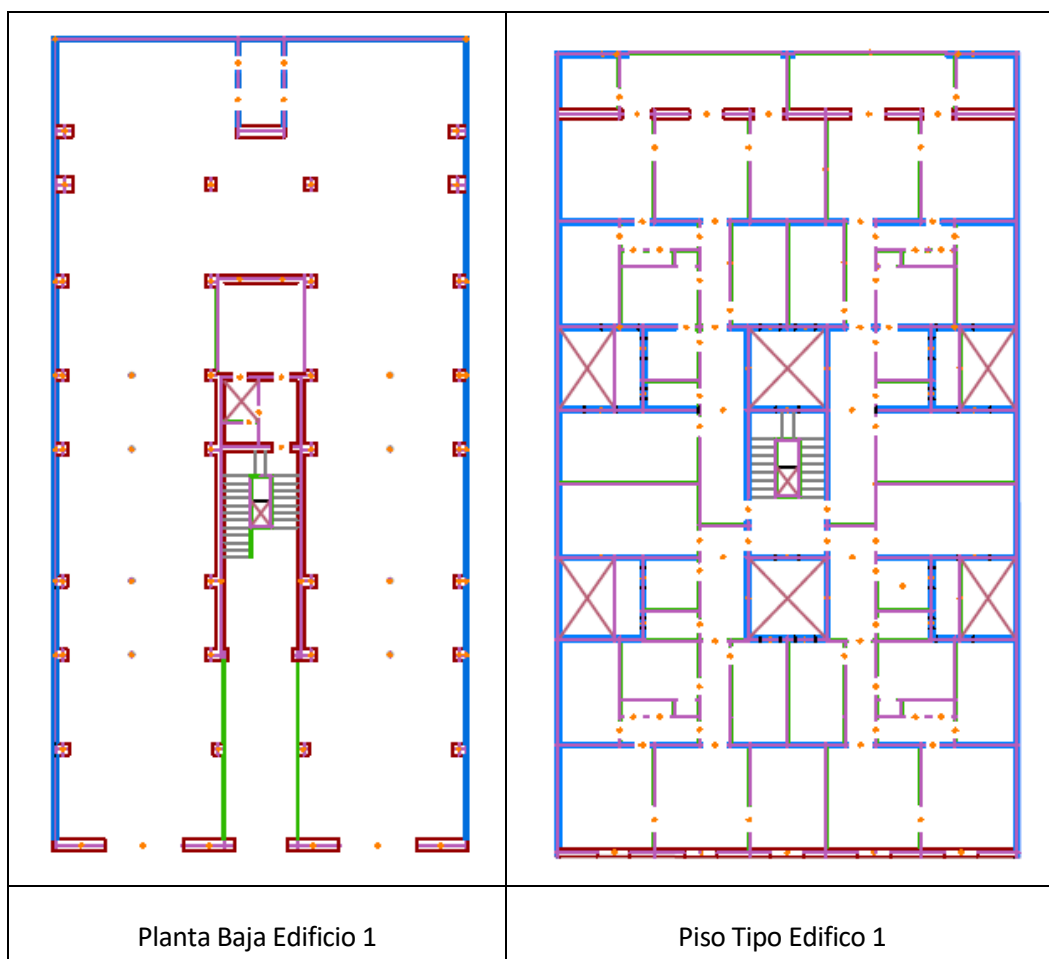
Distribución de las plantas del Edificio 1 (Fuente: Jorge Arturo Ávila Haro)
